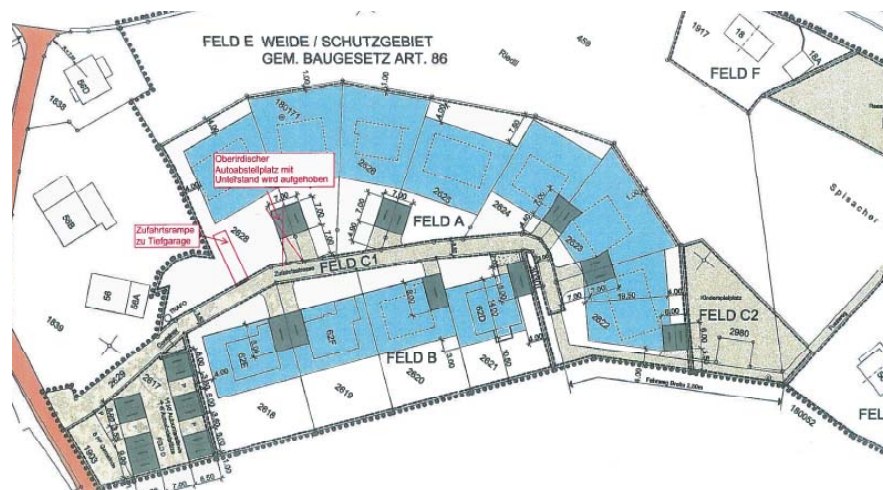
Ausschnitt aus dem ursprünglichen Überbauungsplan (ohne UeO-Änderung mit Perimeter und Baubereichsanpassungen bei Parzelle Nr. 2628) mit Parkplatz auf Feld D (unten links) sowie Reservefläche für Parkierung auf Feld H (beige Fläche am Bildrand oben rechts)
